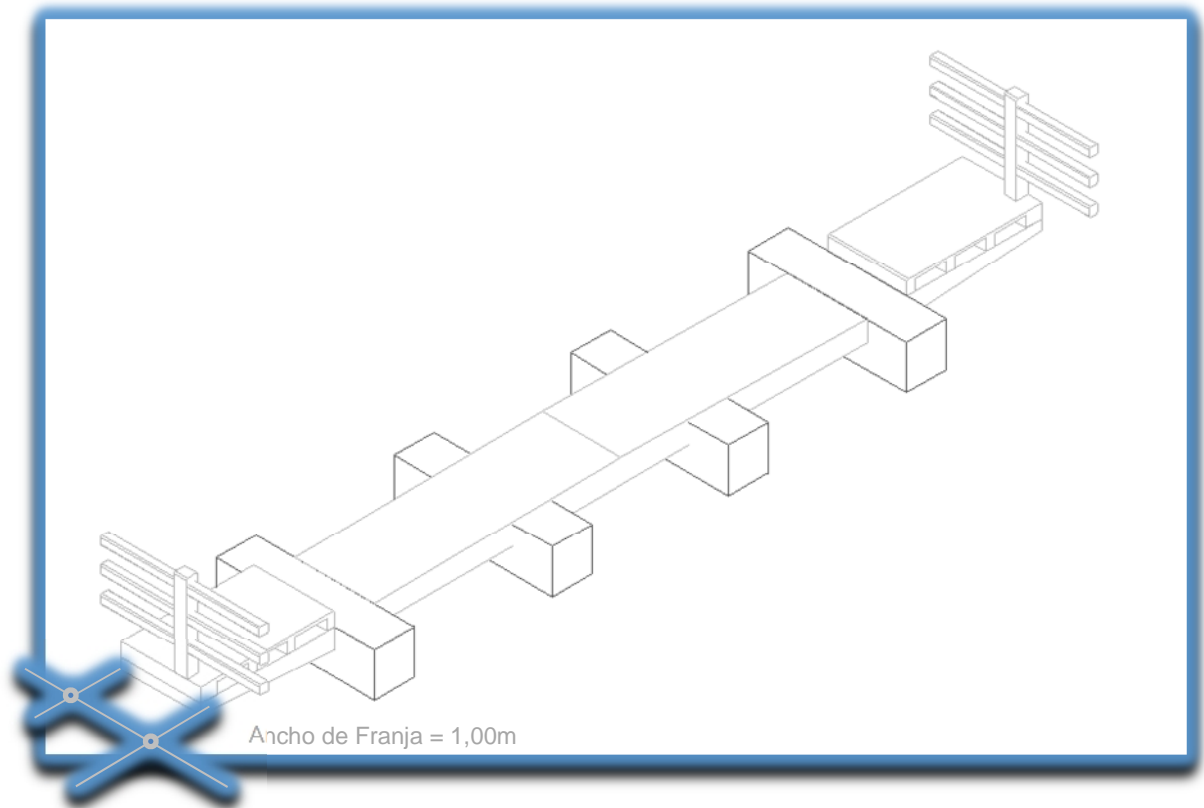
Franja Transversal del Puente. AUTOR Pedro Hurtado L.
